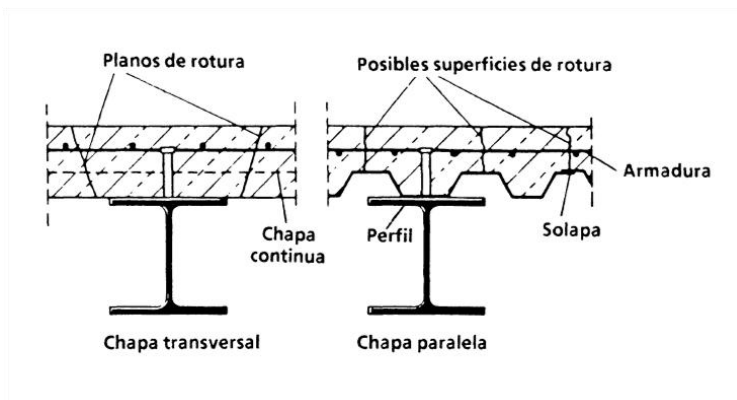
Posibles superficies de rotura por rasante en una losa con chapas de acero nervadas
